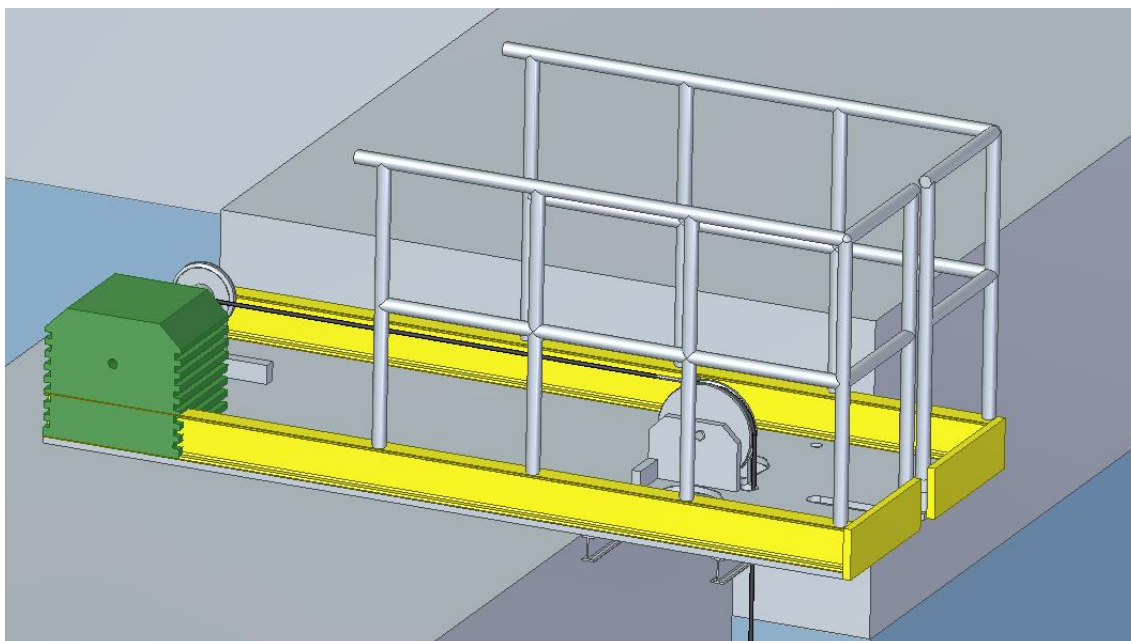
Ubicación en borde de piletas de la plataforma soporte
